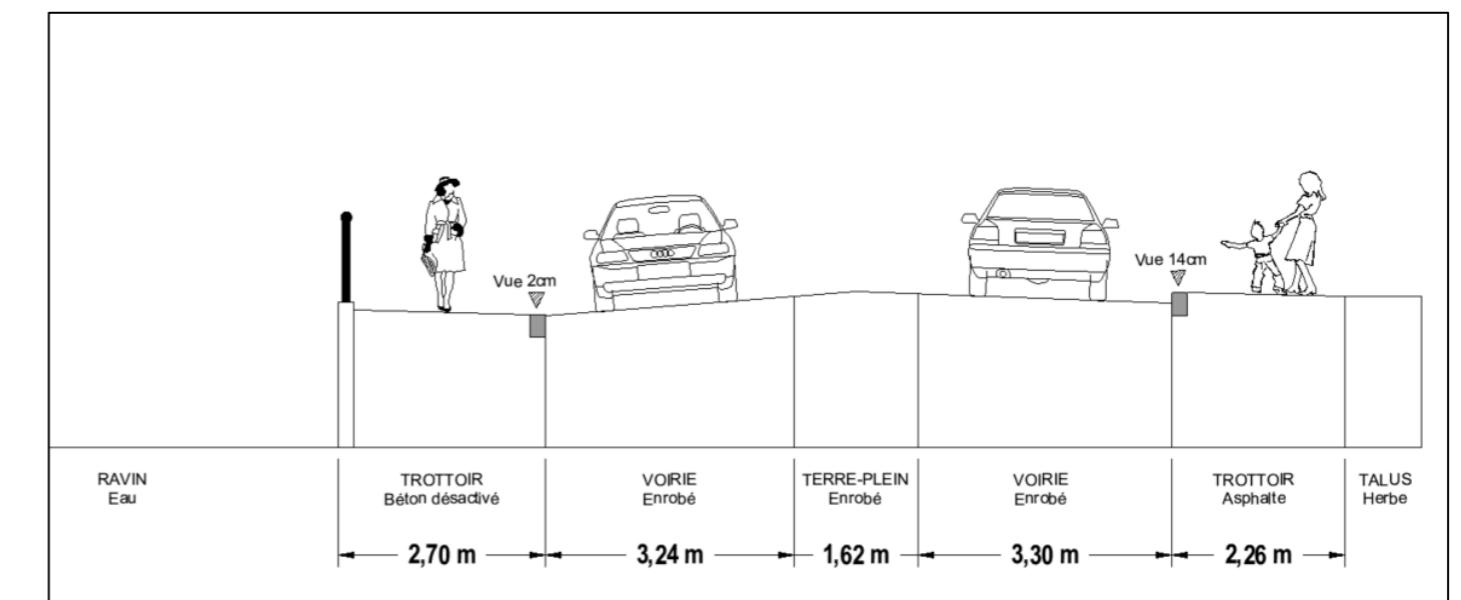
Avenue de la Prairie – Ouvrage de franchissement - Profil en travers existant - Setec / Signes-Paysages
